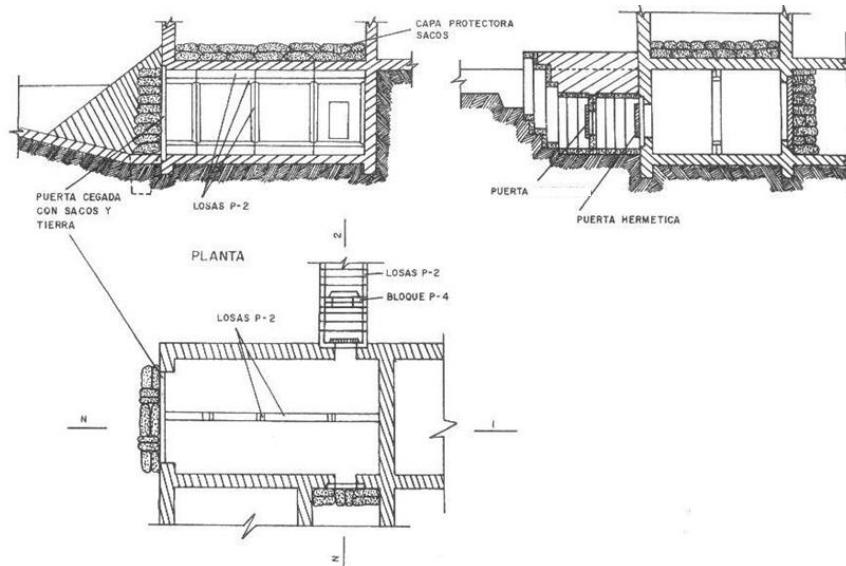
Adaptación de un garaje con abrigo reforzado utilizando losas de hormigón armado con puntales y vigas.
